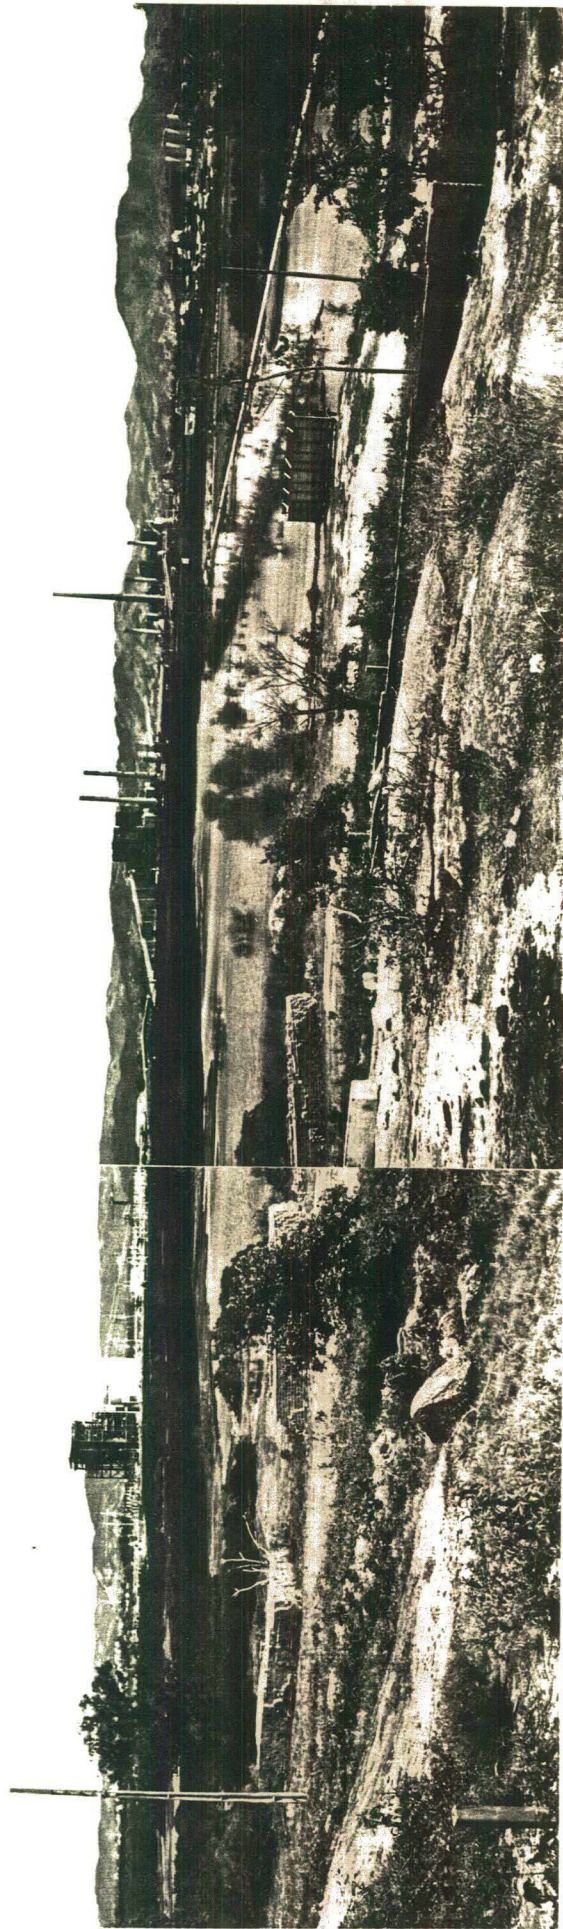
Vista geral do Complexo Termelétrico Jorge Lacerda I, II, III e IV, em construção (à esquerda da Foto). Em primeiro plano a bacia de decantação dos efluentes líquidos.
